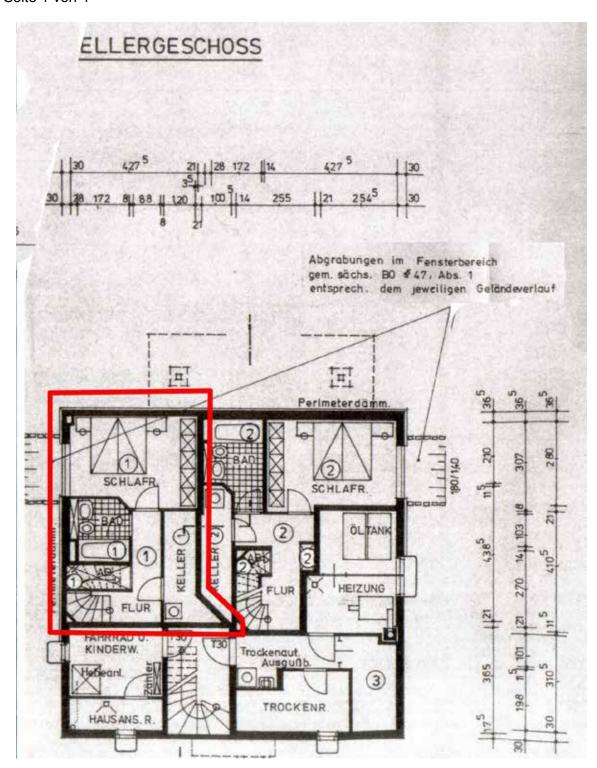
Grundriss des Kellergeschosses (mit Kennzeichnung der Lage des Sondereigentums)
